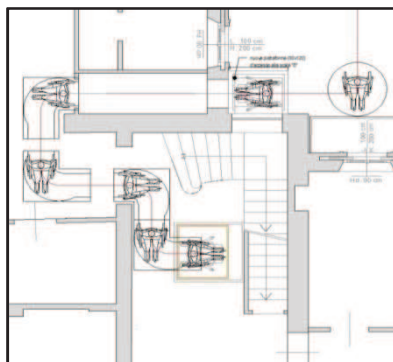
PARTICOLARE PIANTA ACCESSIBILITA' vano ascensore scala B
